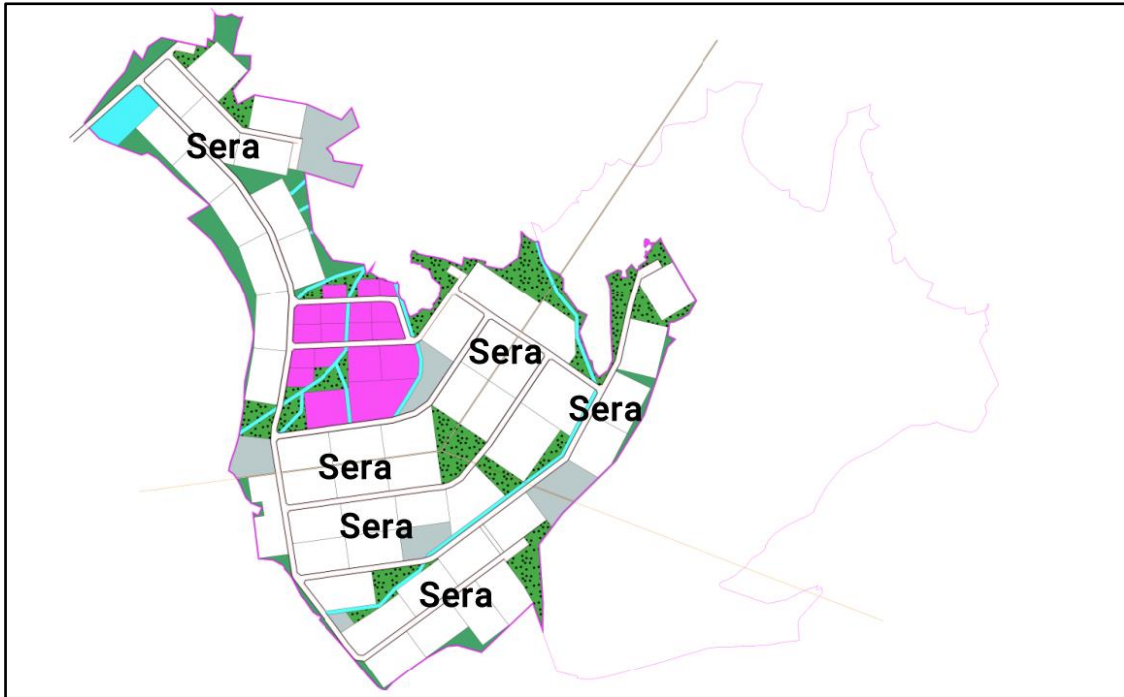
TDİOSB Alanı Genel Yerleşim Planı
